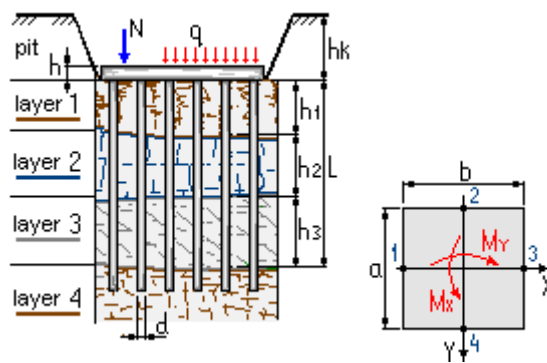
Схема к расчету свайного основания по первому предельному состоянию.
